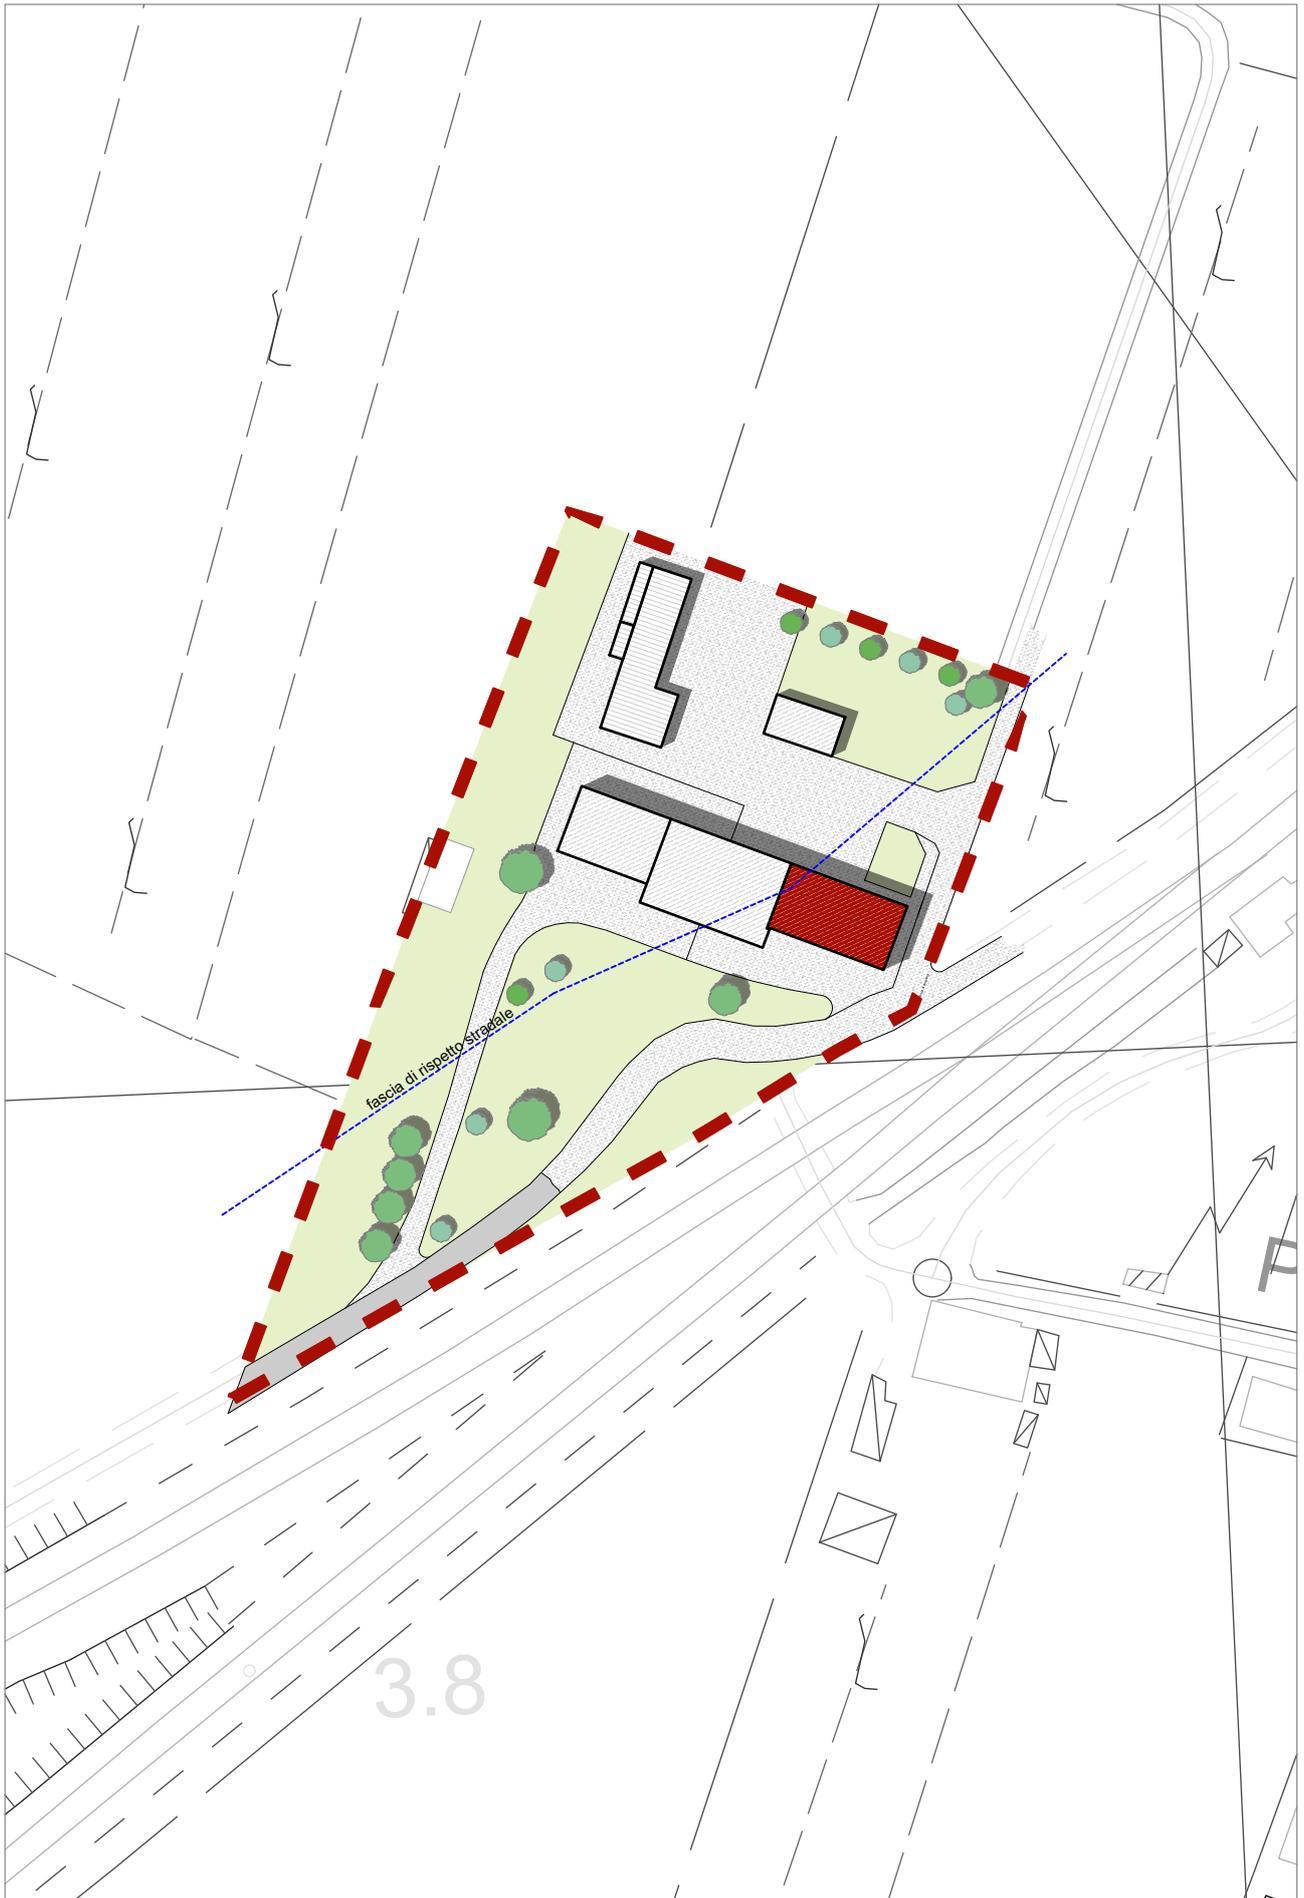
PLANIMETRIA STATODI FATTO. Scala 1:1000
